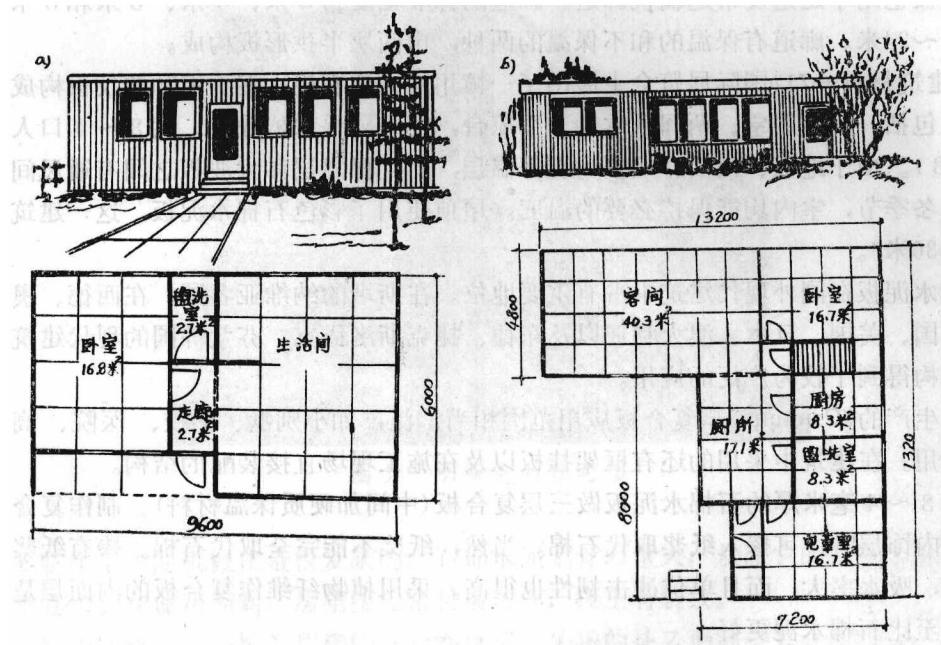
用《AZ-PUR-AZ》板装配的建筑物立面图和平面图
